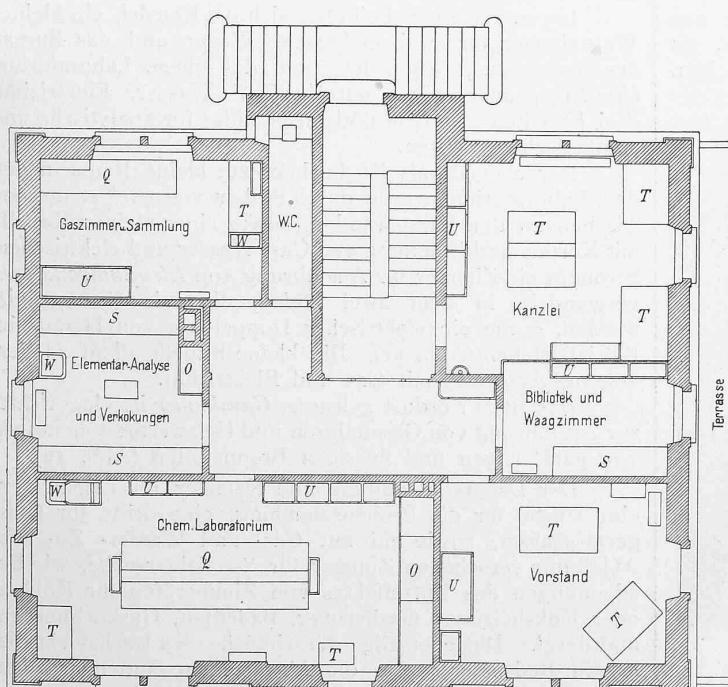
Grundriss des I. Stockes. — Maßstab 1:150.
